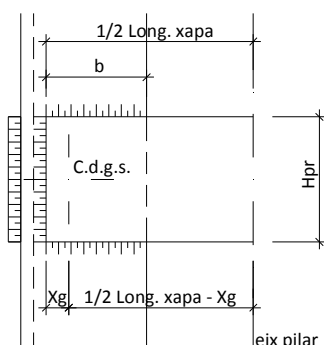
Esquema soldadura amb dades geomètriques
